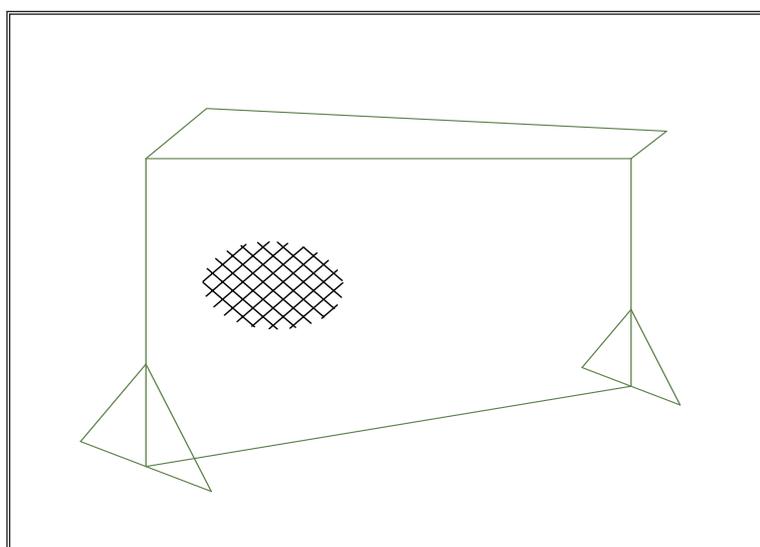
Pantalla portátil, 2.5 m x 3 m., cubierta con malla de 20 a 40 mm.
